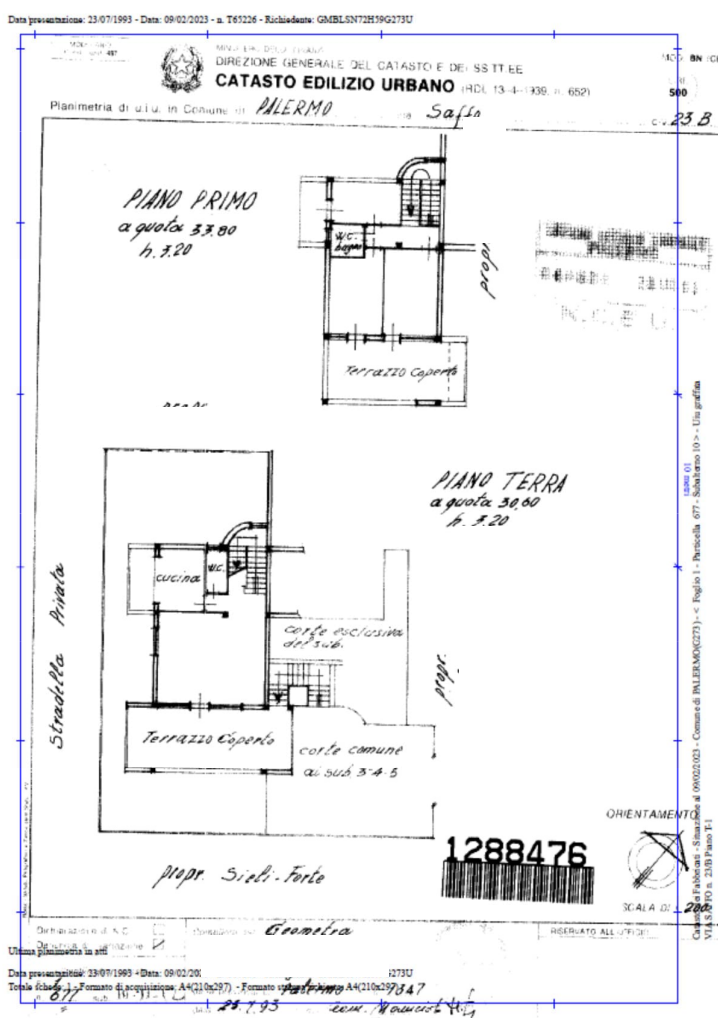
ultima planimetria catastale in atti dei sub 10-11-12
